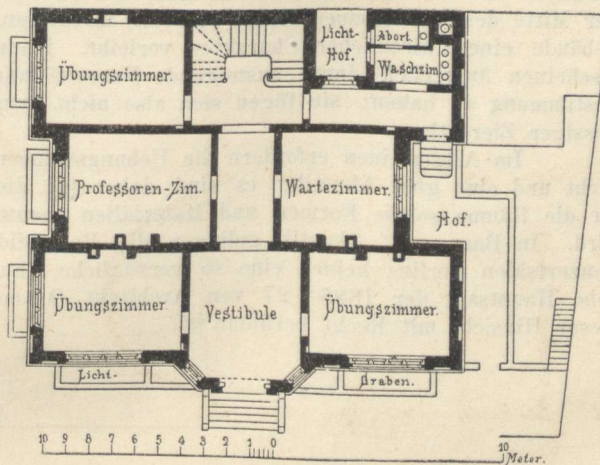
Grundriss vom Erdgeschoss.
